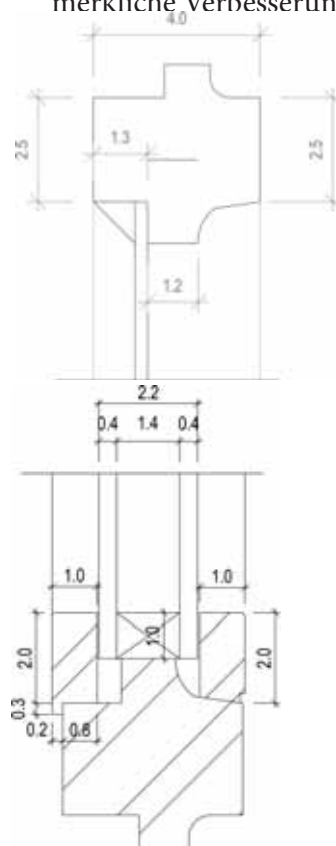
Detailplan Fenster ca. 1900 (oben mit Originalverglasung, unten mit Wärmeschutzglas)
